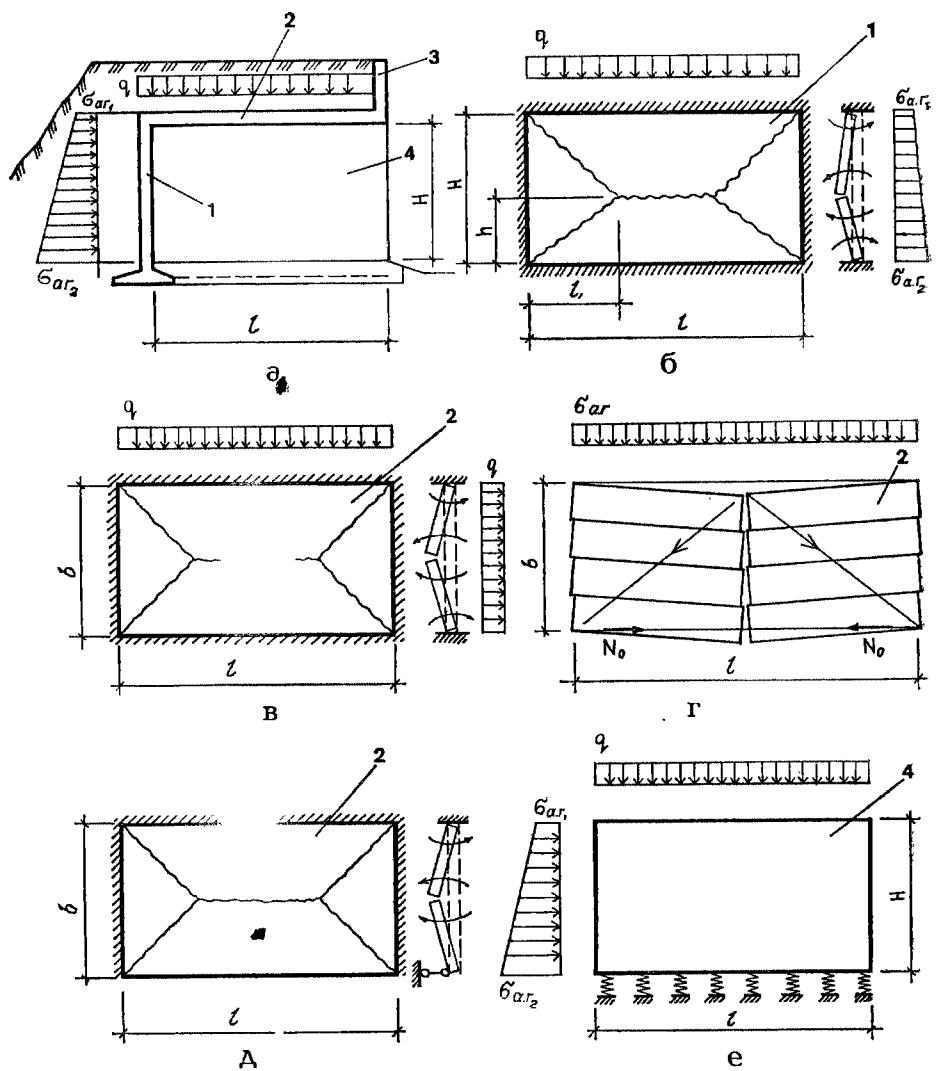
Расчетная схема элементов обвалованных жилых зданий:
